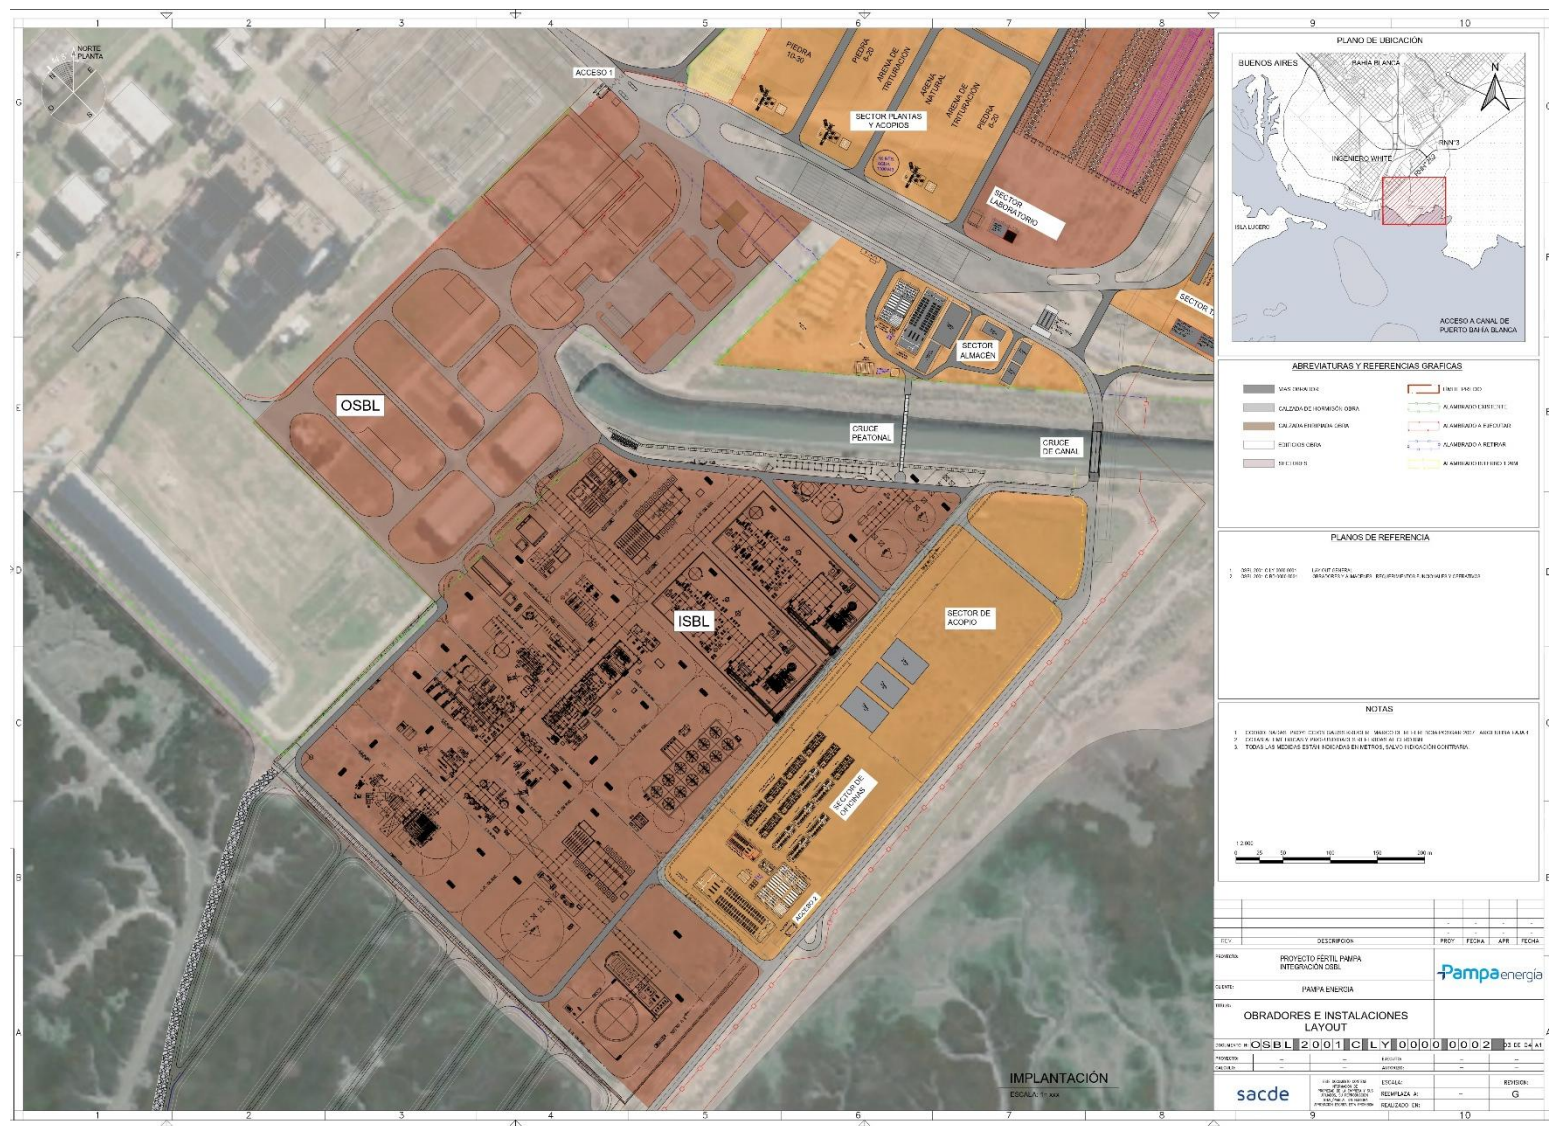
Layout de Obradores e instalaciones temporales en etapa constructiva.
